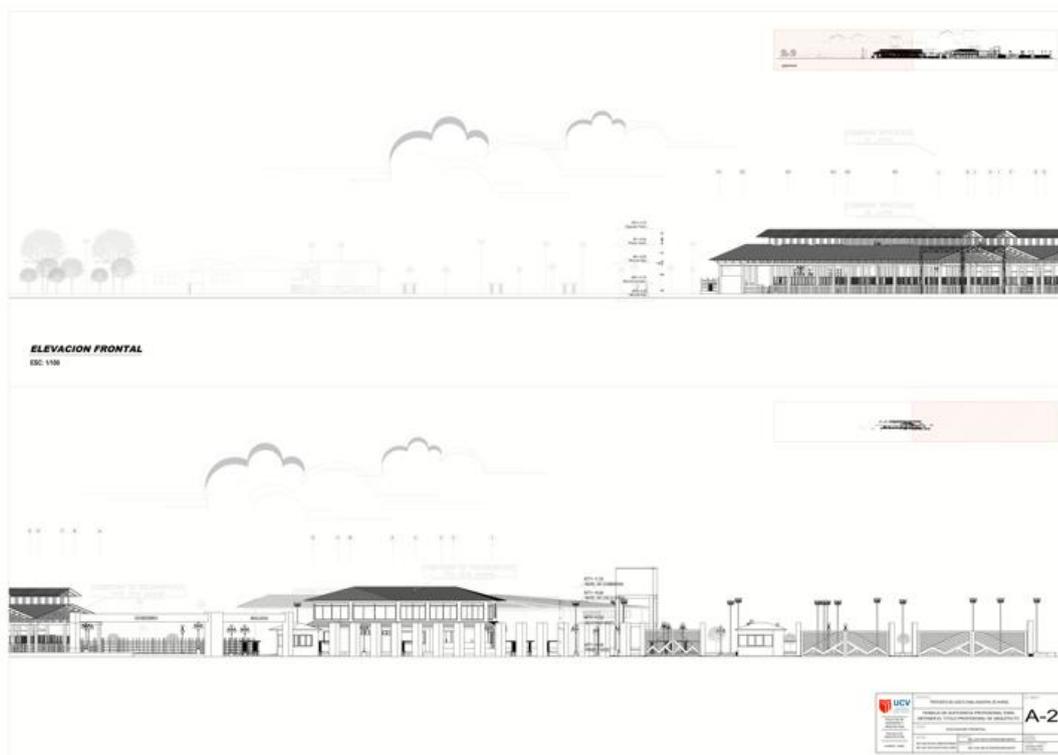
Plano de Elevacion Lateral en zona de Corrales
